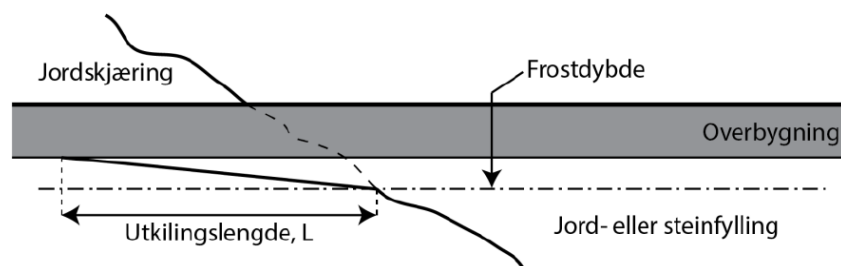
Utkiling ved overgang fjellskjæring/telearlig grunn eller underbygning /1/
